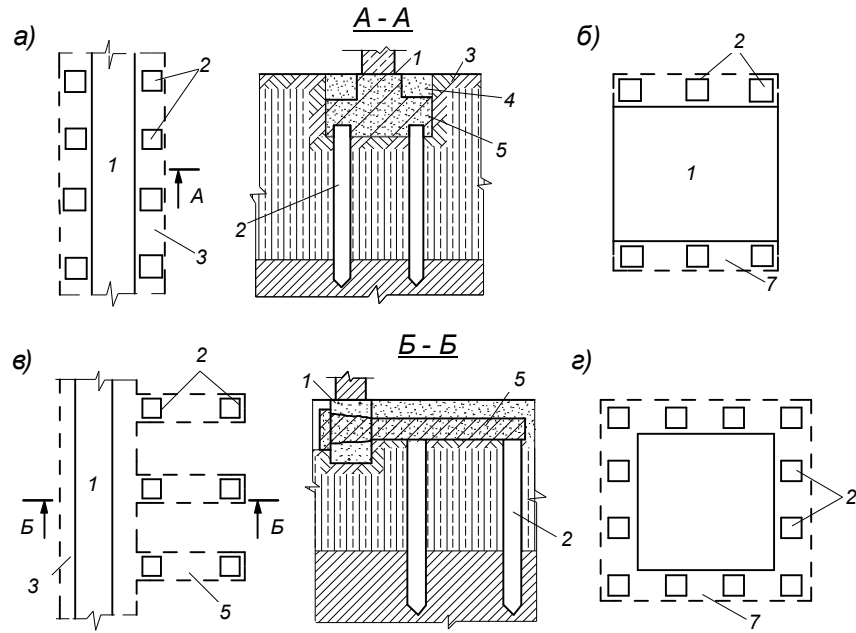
Схеми розміщення виносних паль при підсиленні стрічкових (а, в) і стовпчастих (б, г) фундаментів [37]:
